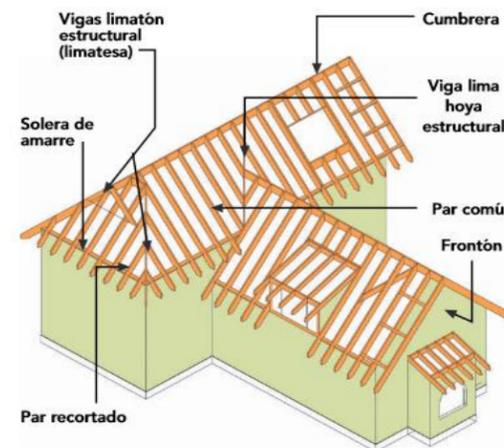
Estructura de Techo. Sistema de diafragma inclinado Fuente: Héctor Scerbo estructuras en madera 1996
